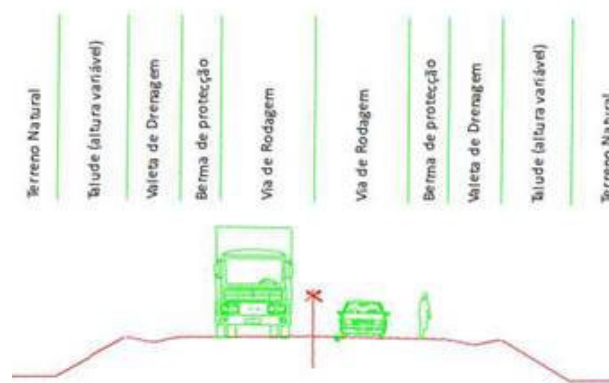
Perfil transversal proposto para a estrada de acesso ao cais fluvial
